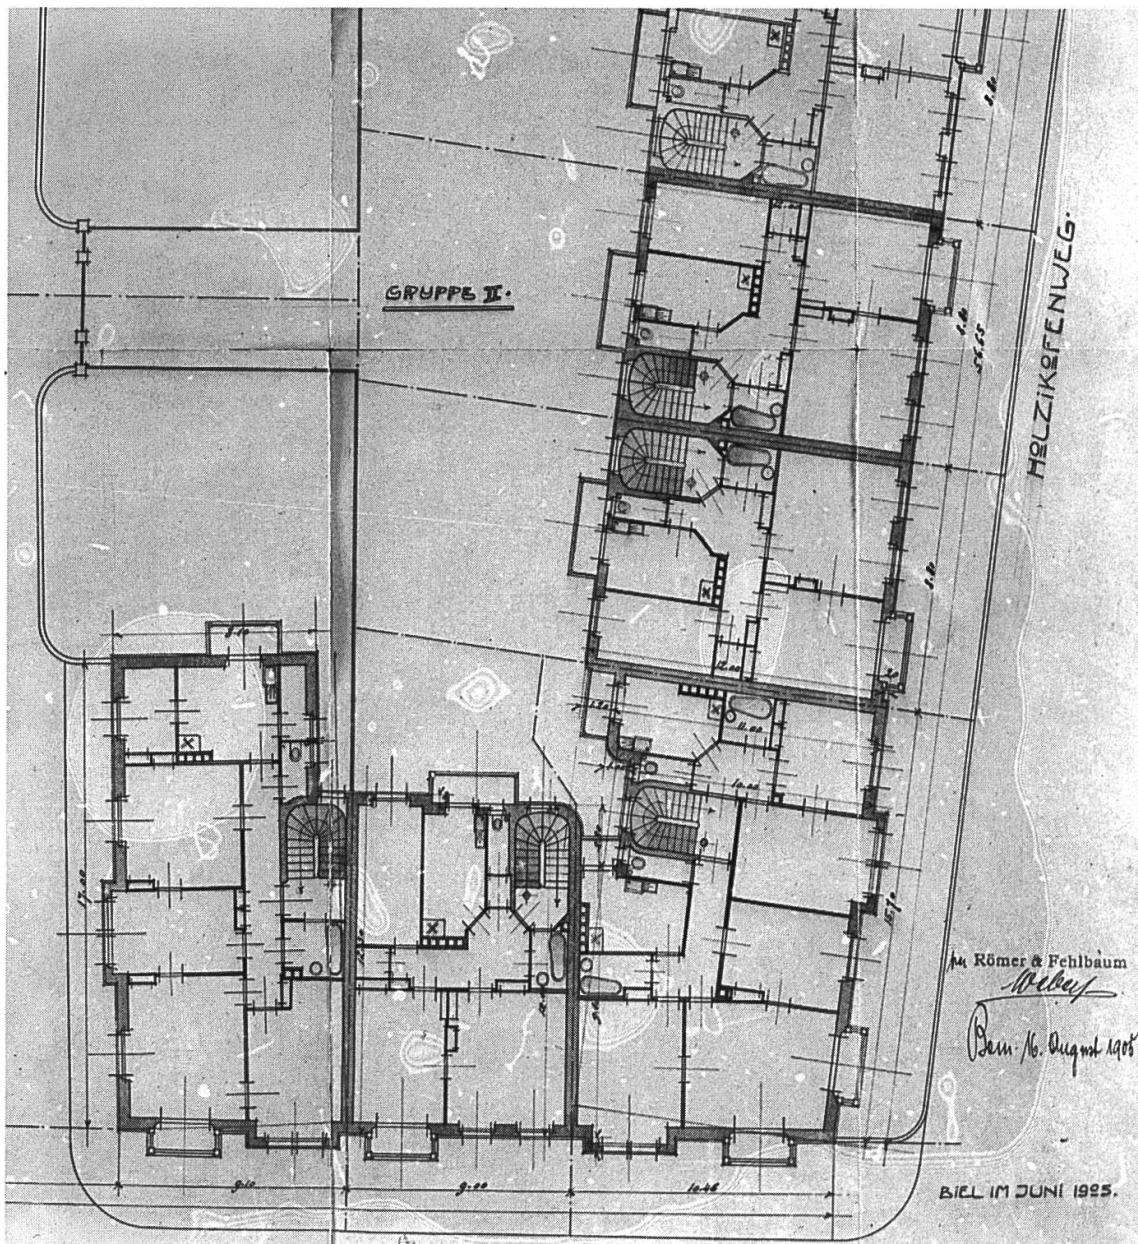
Seftigenstrasse / Holzikofenweg. Grundriss von 1905.
